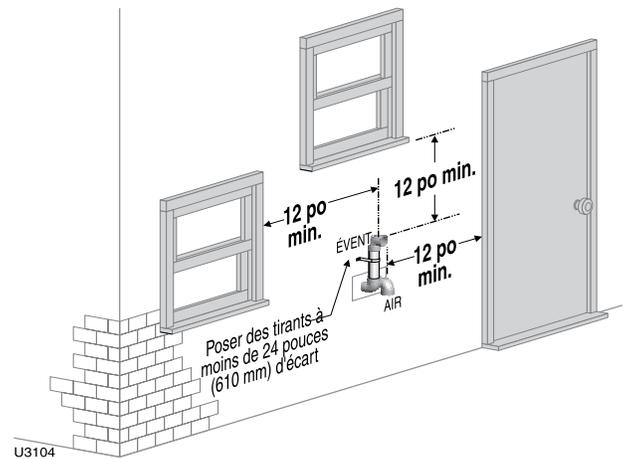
Terminaison murale avec tuyaux séparés – Dégagements entre sortie d'évent et prise d'air forcé
